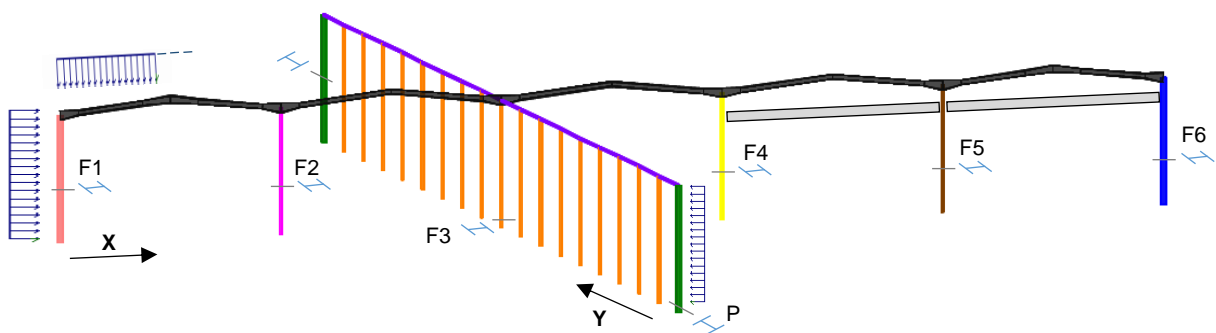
Orientação e nomenclatura adotadas para os pilares (perfis em I apenas representativos).
